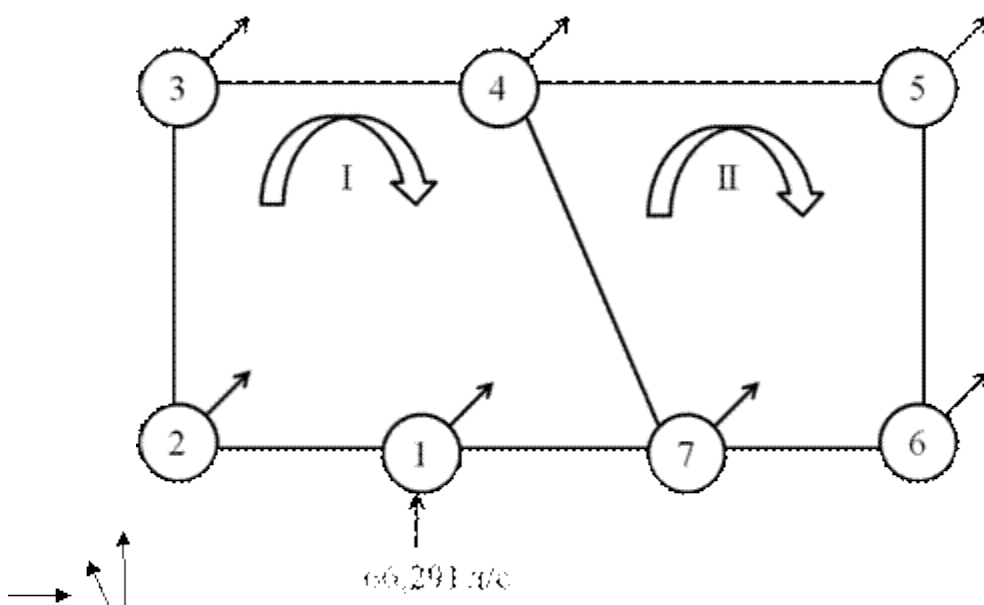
Расчетная схема водопроводной сети с узловыми расходами
